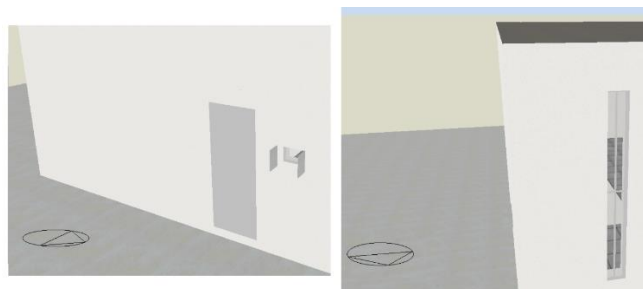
Janela na fachada Este e na Fachada Norte.
